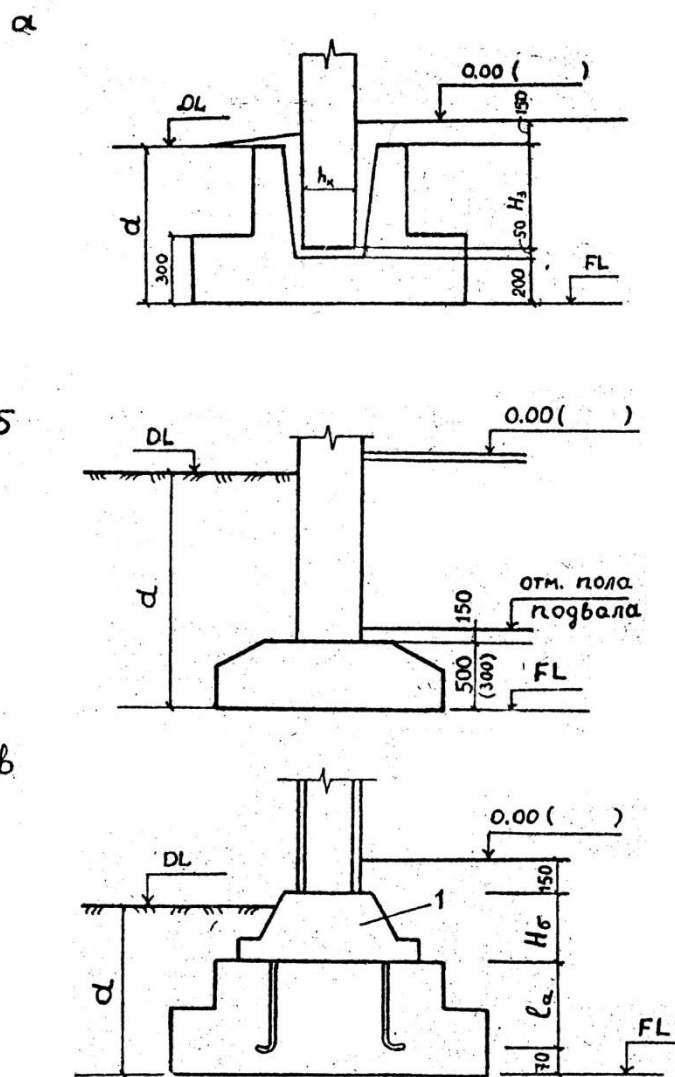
Определение глубины заложения фундаментов с учетом конструктивных особенностей здания: а – фундамент под железобетонную колонну; б – ленточный фундамент под стену; в – фундамент под металлическую колонну; 1 – база колонны.
